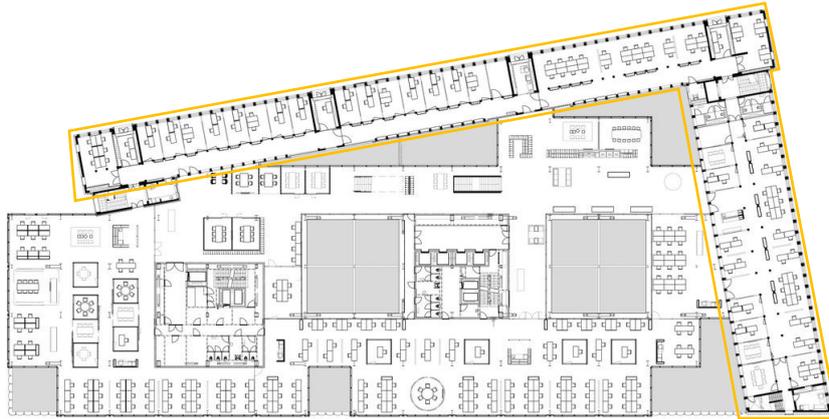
Timmerhuis: Planta Baixa térreo e a conexão do acessos em uma “praça” central. Fonte: Archdaily
